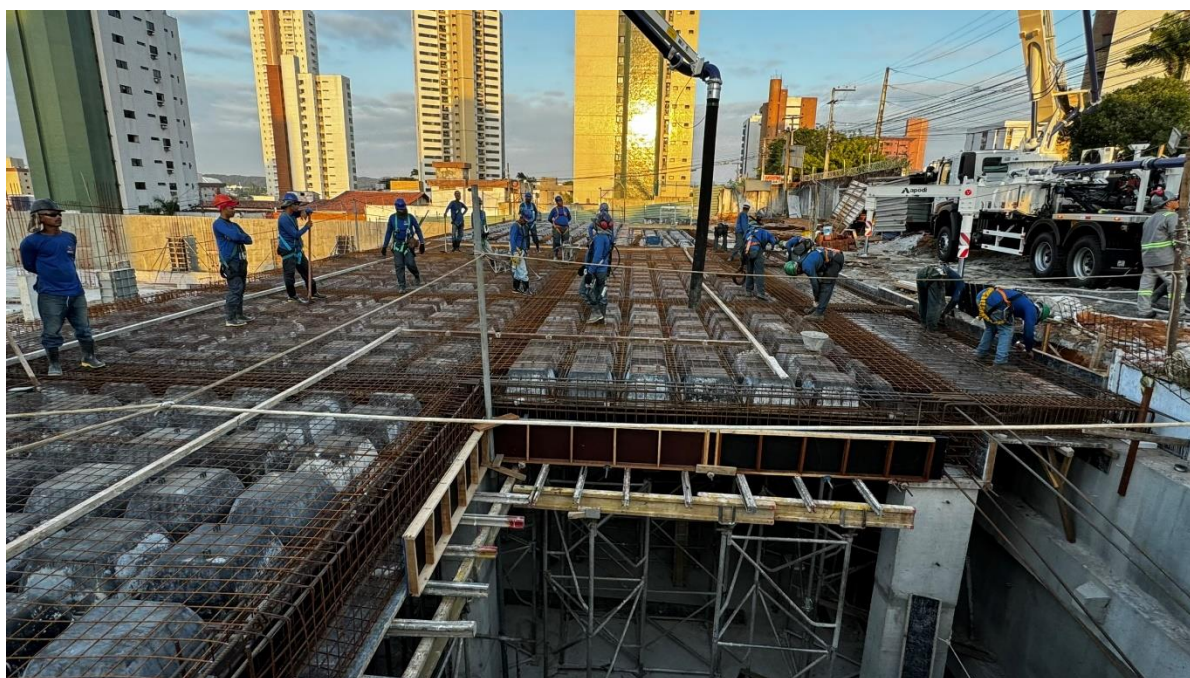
Montagem das cubetas e ferragens do trecho da laje de cobertura do segundo subsolo para ser concretado.
